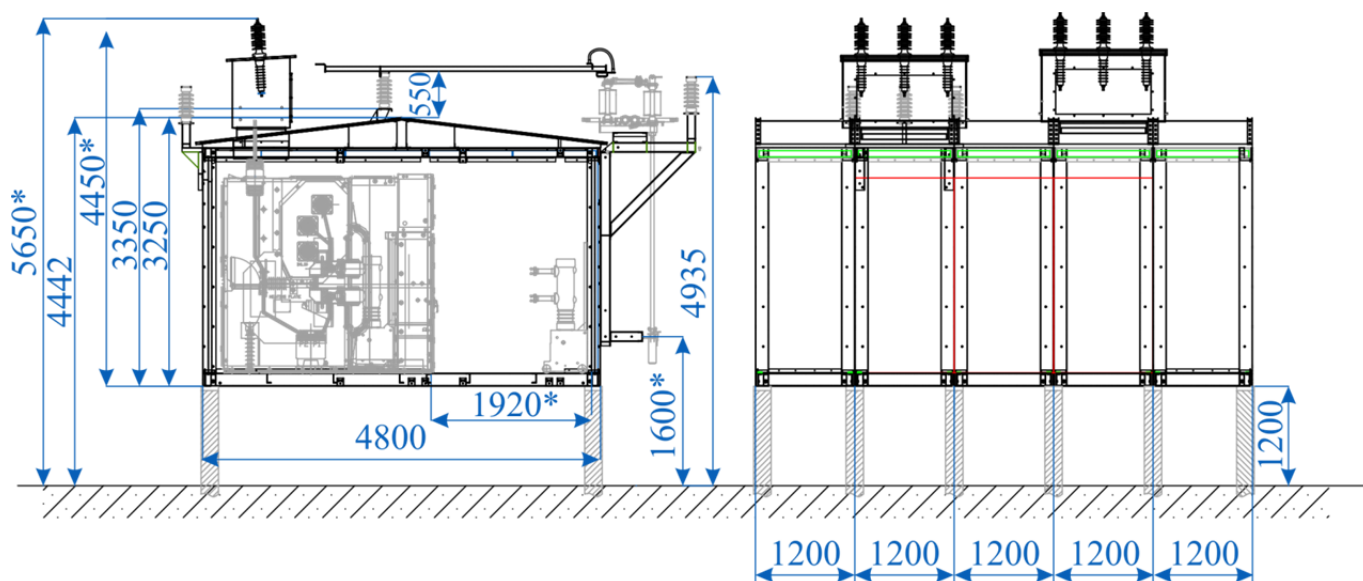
План расположения электрооборудования в КРУ-35 кВ с нанесением сетей освещения и вентиляции
